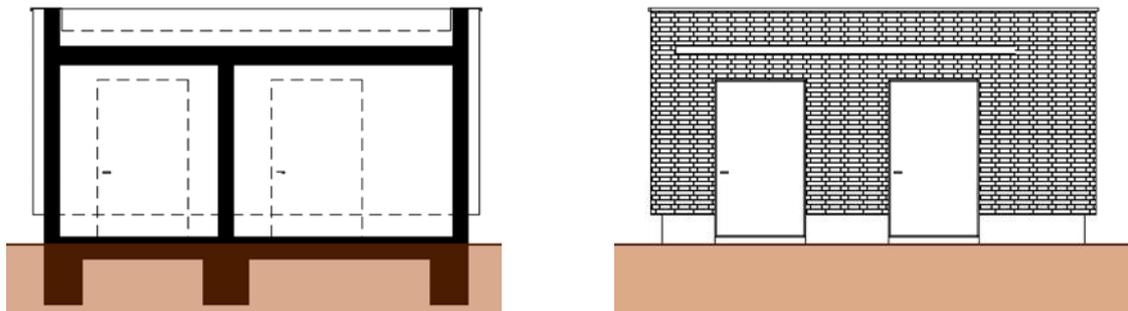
Betriebstechnikgebäude, Schnitt und Ansicht
